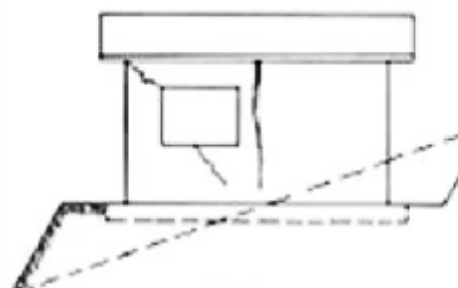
Fissuras oriundas da concentração de tensão no entorno dos vãos
